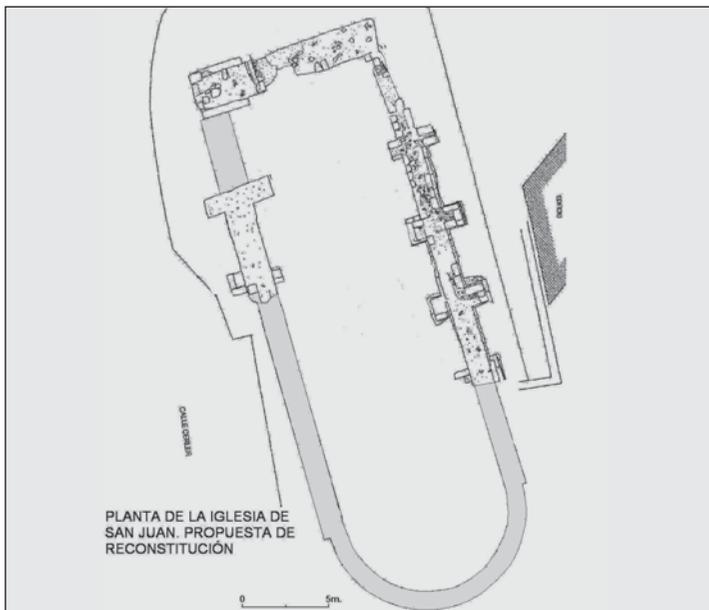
Planta de la iglesia de san Juan. Propuesta de reconstitución.
